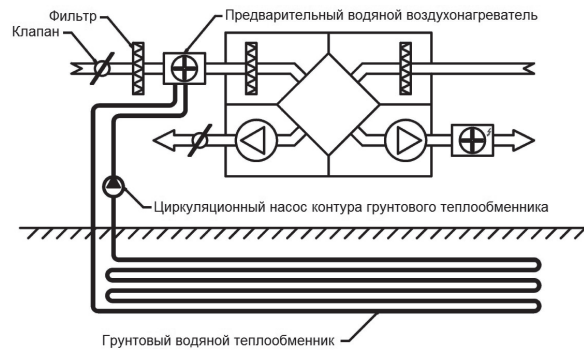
Использование водяного грунтового теплообменника для предварительного подогрева воздуха
